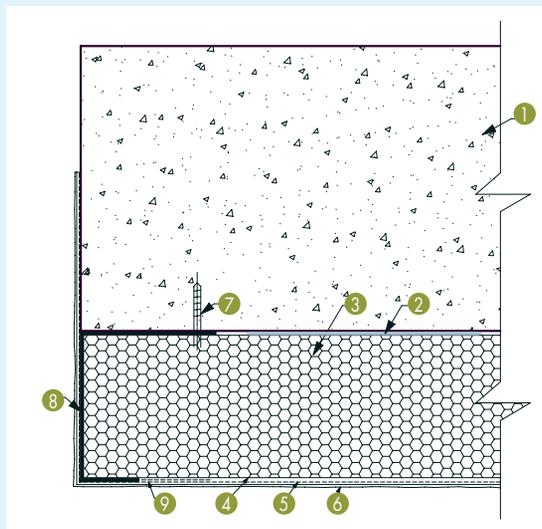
Arrêt latéral d'angle (coupe horizontale)
